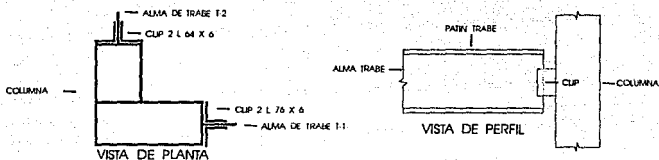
DETALLE DE UNION TRABE - COLUMNA
